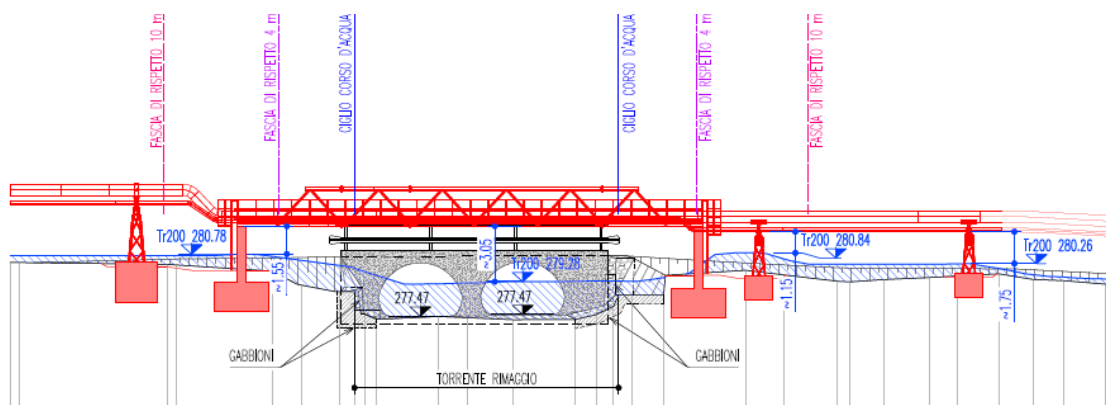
Attraversamento A2 sul torrente Rimaggio (TC8892) – Vista in sezione
